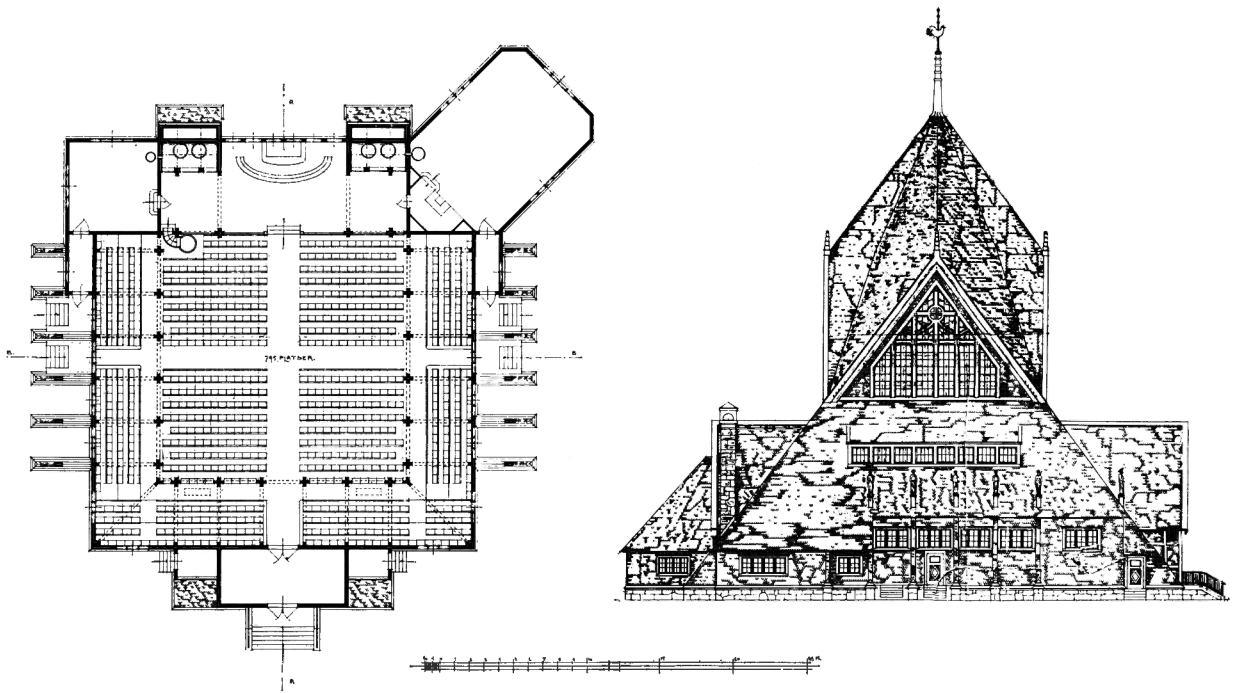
Ritning till plan och nordfasad enligt förslag av Gustaf Wickman i april 1908. Kyrkoarkivet.
